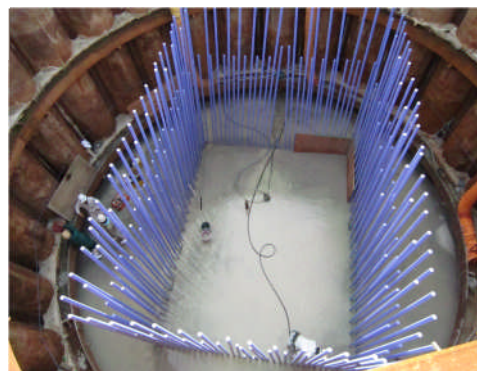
P4頂版コンクリート打設後 (打継目処理中)
